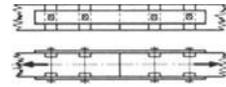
Zugstoß eines einteiligen Untergurtstabes unter Verwendung von Stahllaschen.
